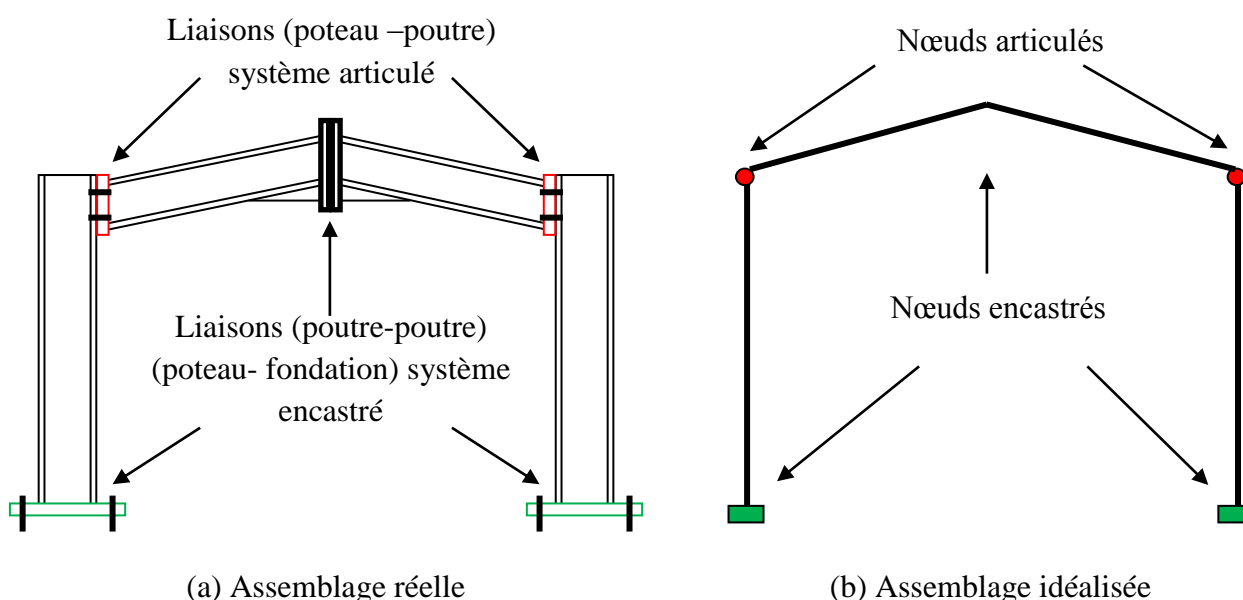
Assemblage courant d'un portique métallique : poteau-poutre, poutre- poutre et poteau-fondation.
